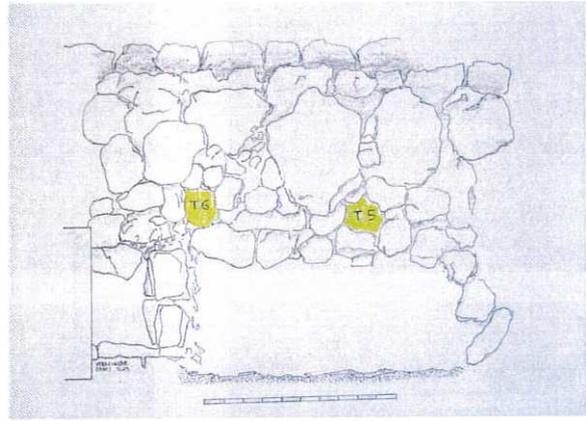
Les deux premiers trous de poteaux du mur Nord. (Photo et croquis D. Mellinger)
